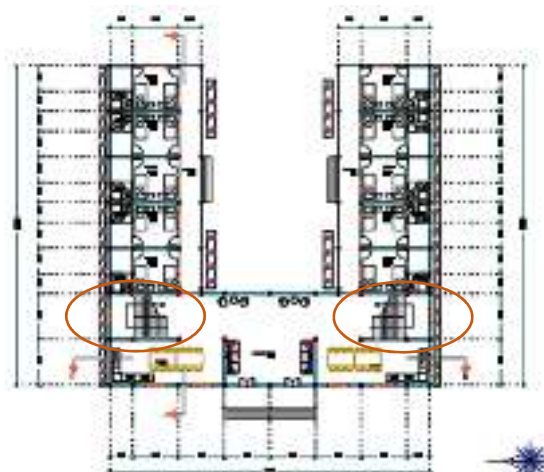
21: Penerapan fasad atau selasar panjang pada bangunan utama gereja yang menjadi sirkulasi horisontal
